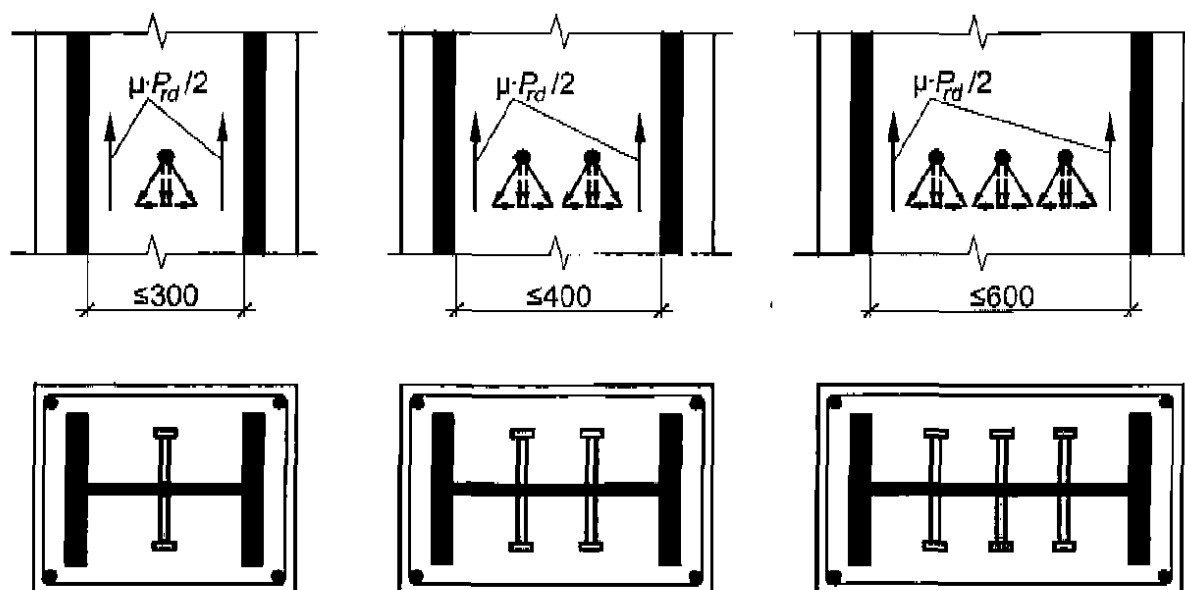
Схемы установки гибких упоров в сталежелезобетонном элементе на примере сечения с жесткой арматурой двутаврового очертания
